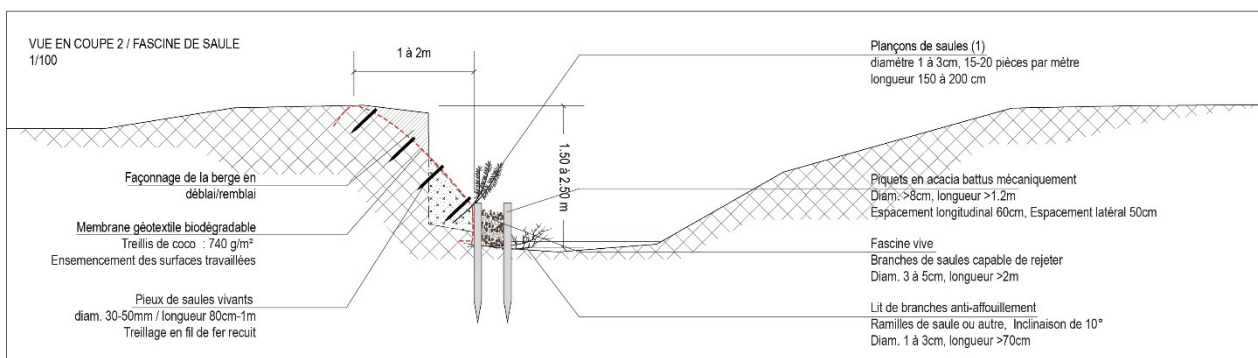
Vue en coupe fascine de saule et reprofilage de la berge
